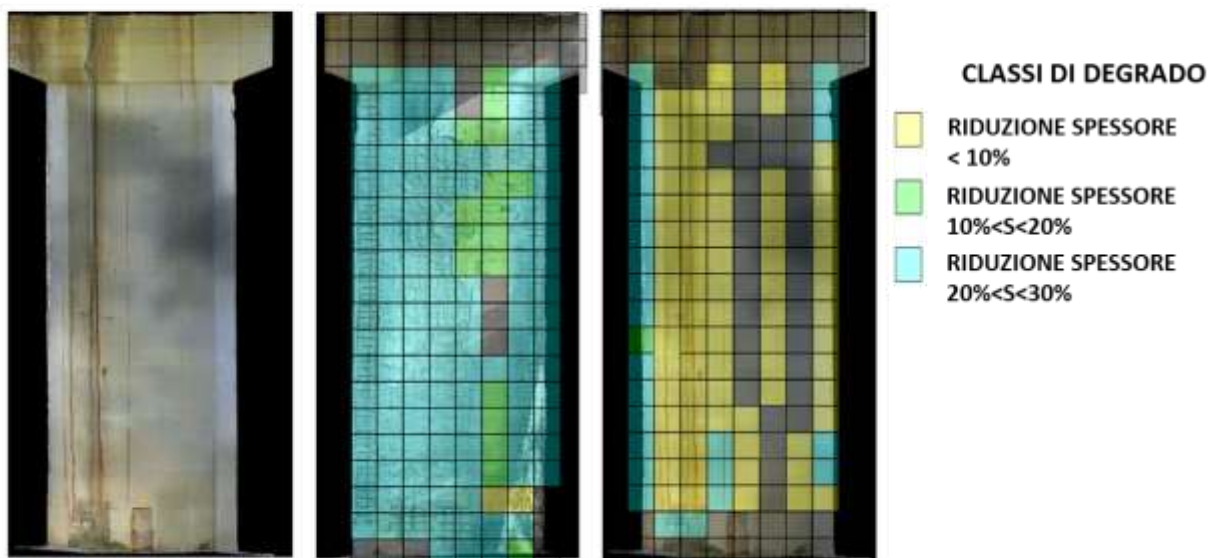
Esempio 2 - Output rilievo Fotogrammetria per degrado su Armatura – Pila
